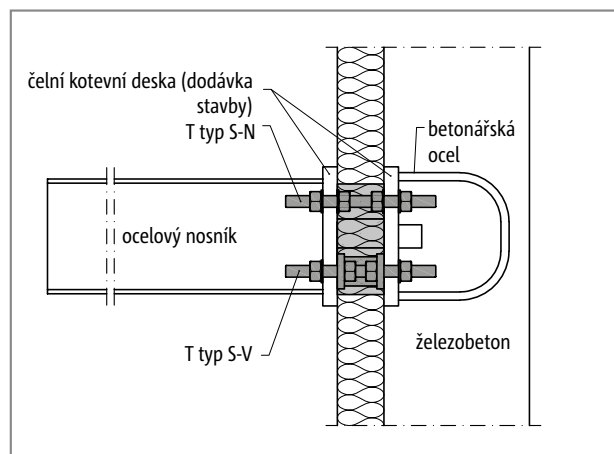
Schöck Isokorb® T typ S: Vnější roh (nárožní markýza)
